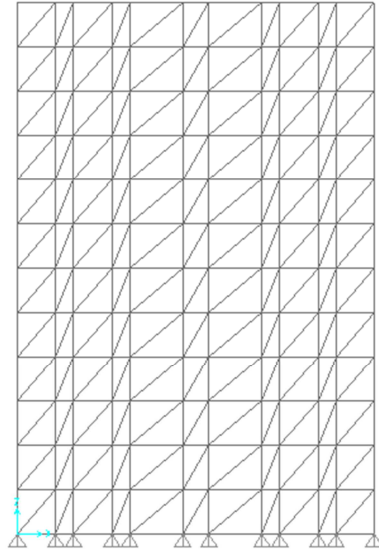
Configuração dos Planos de Contraventamento Vertical Com Elementos de Contraventamento Pequenos
